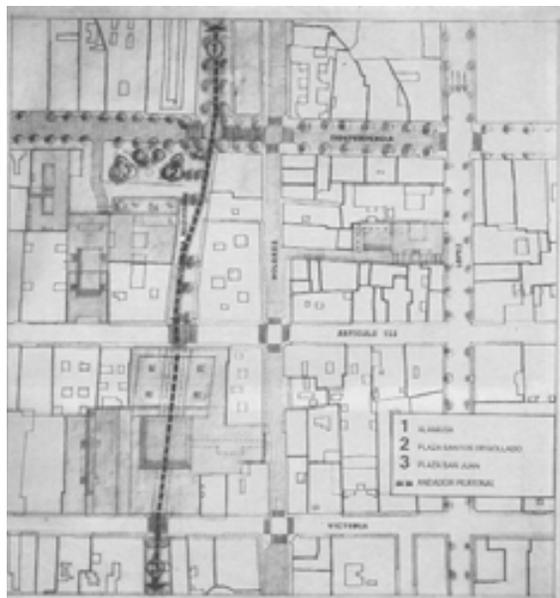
Proyecto de generación urbana de la zona sur de la alameda, planta de viviendas programada de arquitecturas, uam-x.
